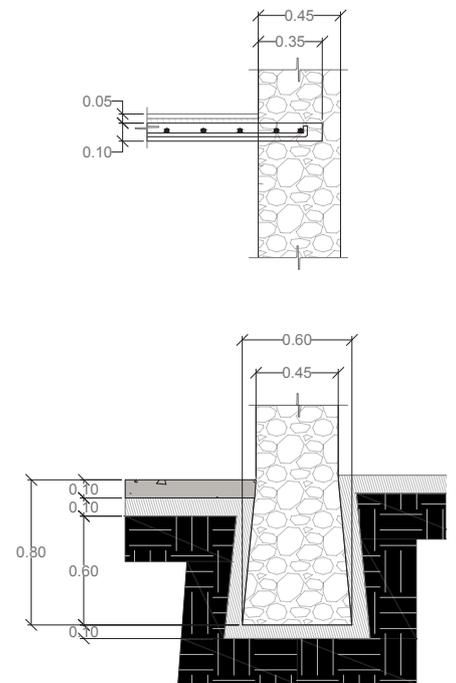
Plano estructural de la cimentación a proponer. Fuente: Elaboración propia.
